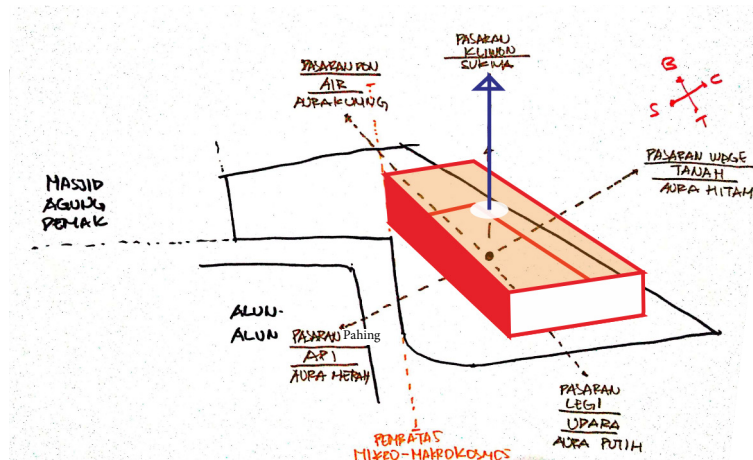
Eksplorasi Site Plan Tahap 2
